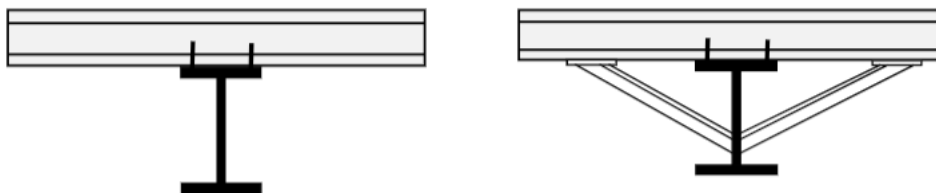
Poutre tenues latéralement par des pannes et des bracons
